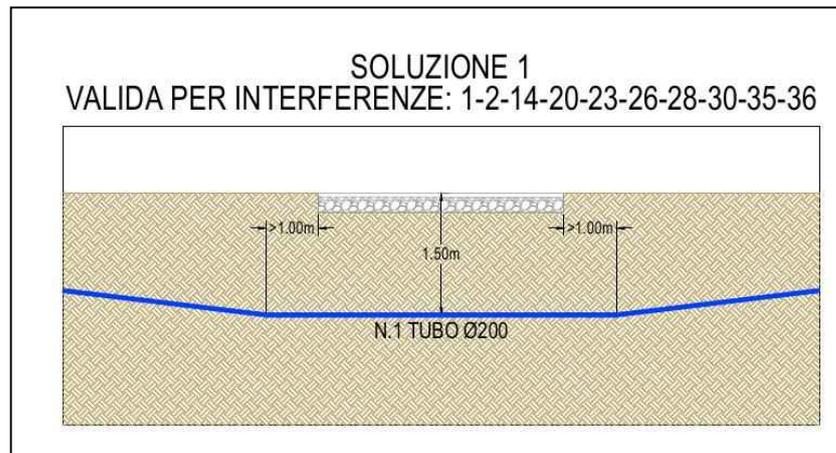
Attrav. Cavidotto sotto strada esistente
